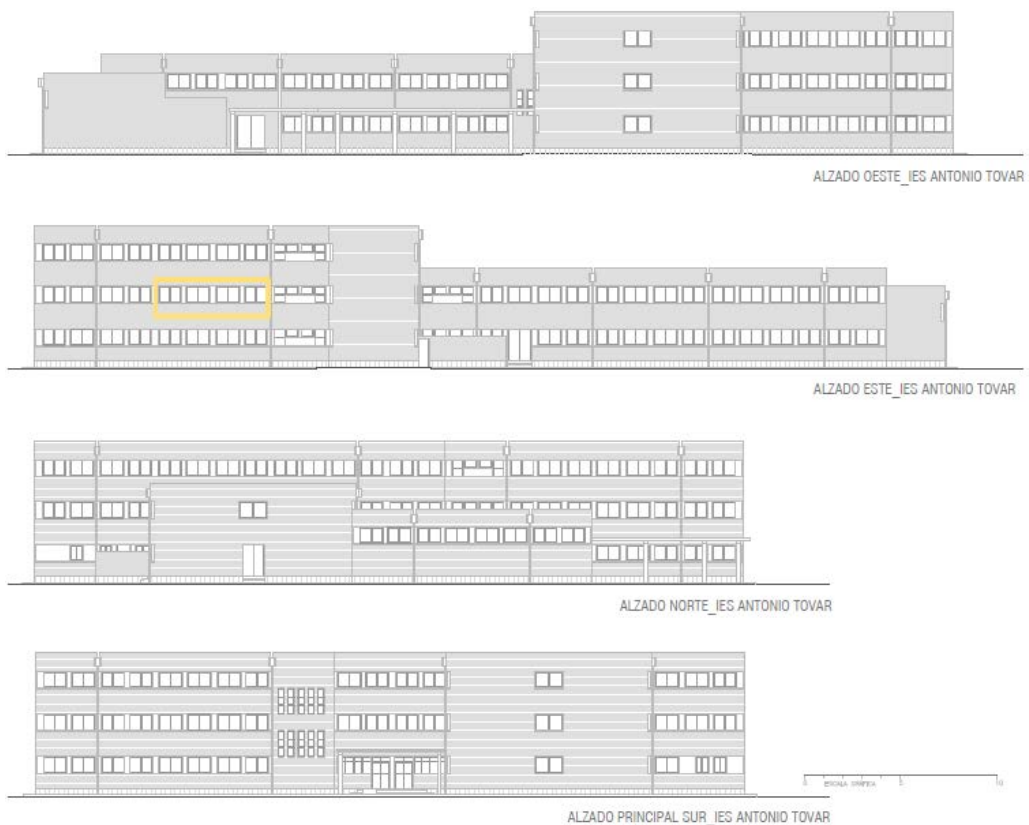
Alzados del IES Antonio Tovar. Módulo de fachada correspondiente a un aula.
